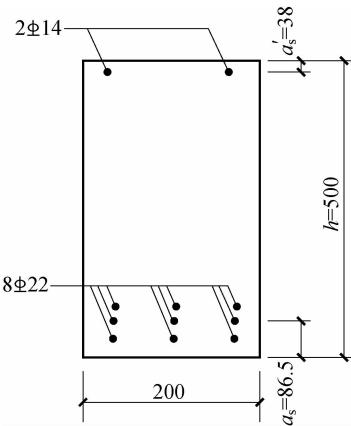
【例 3-3】配筋(尺寸单位:mm)
